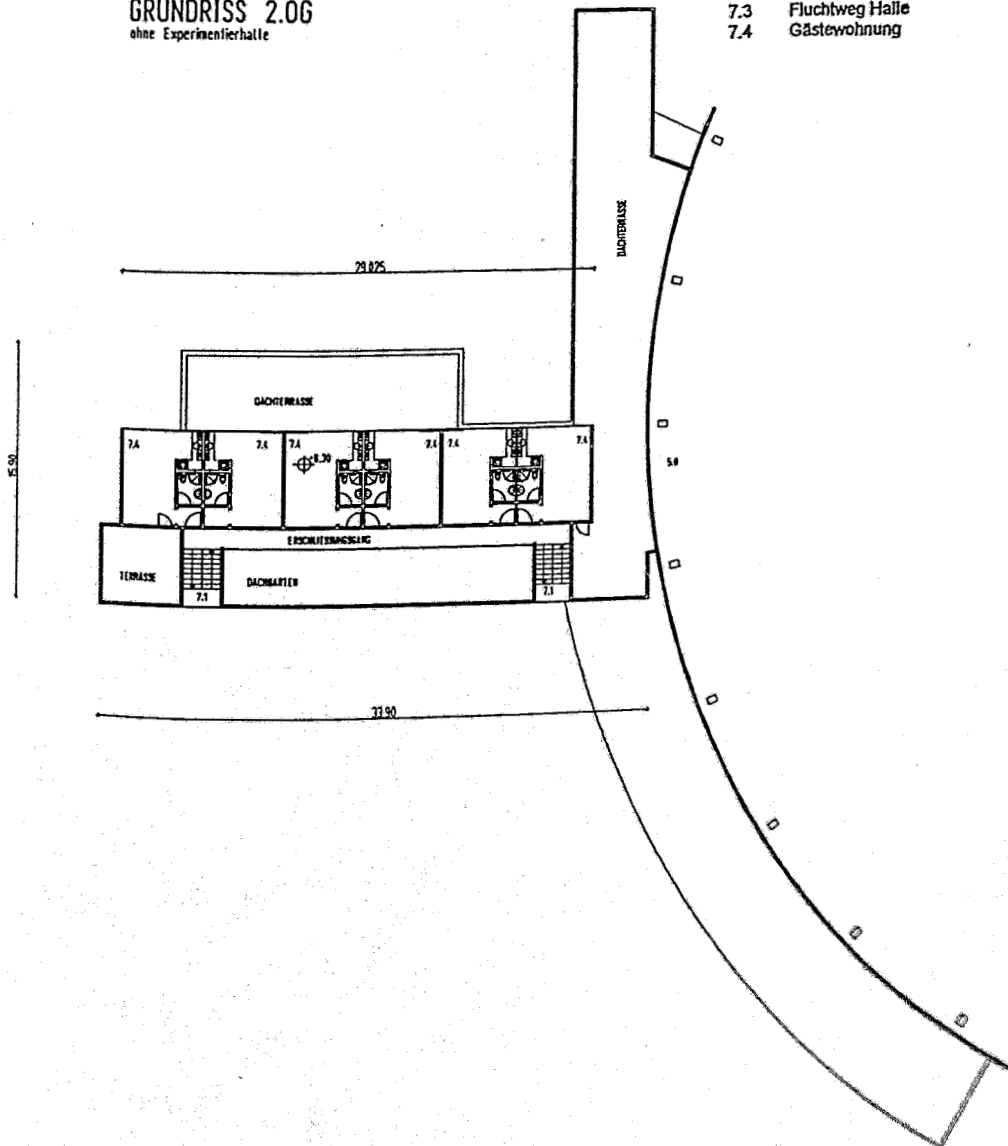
Grundriß des zweiten Obergeschosses mit Gästewohnungen
